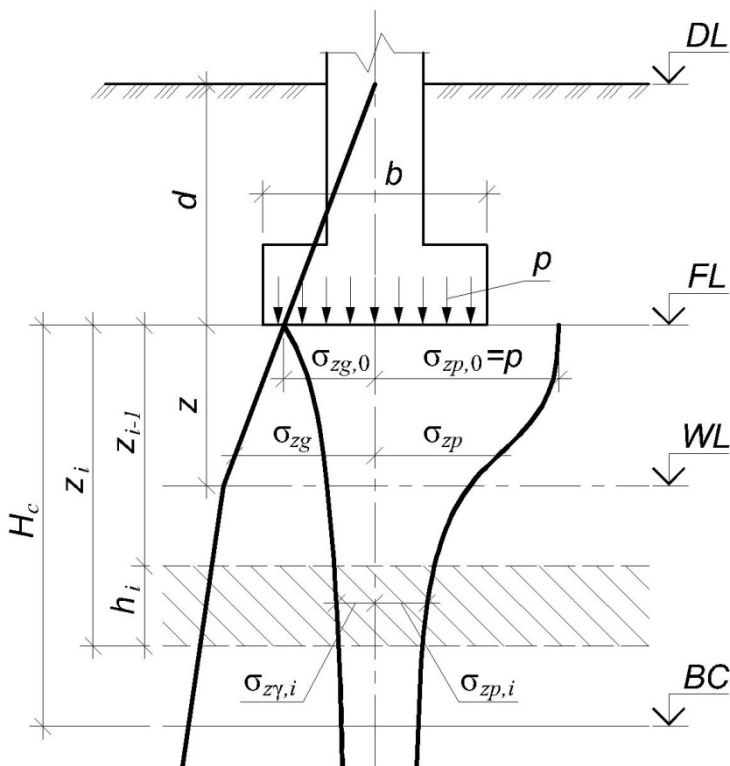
Расчетная схема для определения осадки фундамента методом послойного суммирования:
